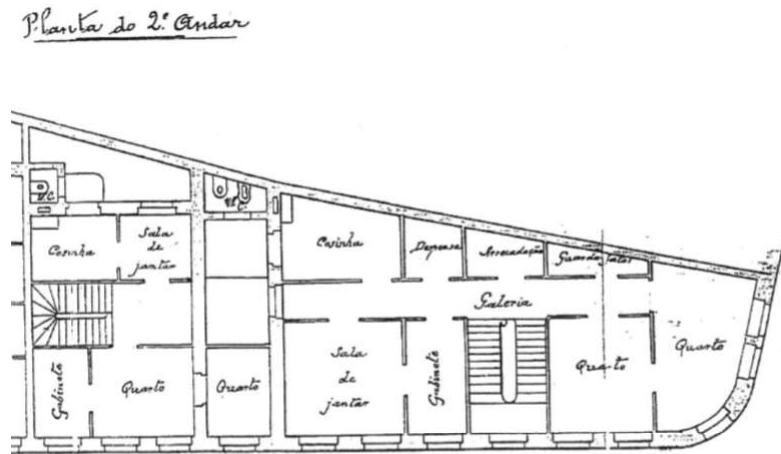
Planta do 2º Andar; primeiras plantas detetadas
